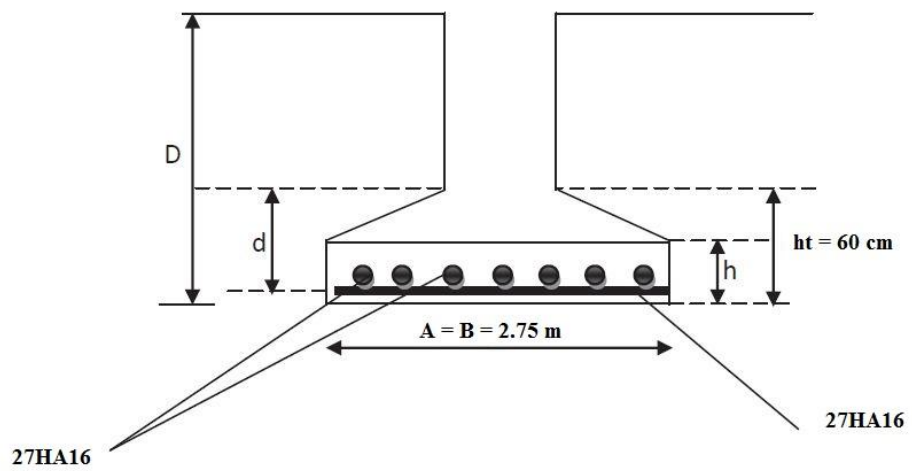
coupe de ferrailage de semelle isolée centrée
